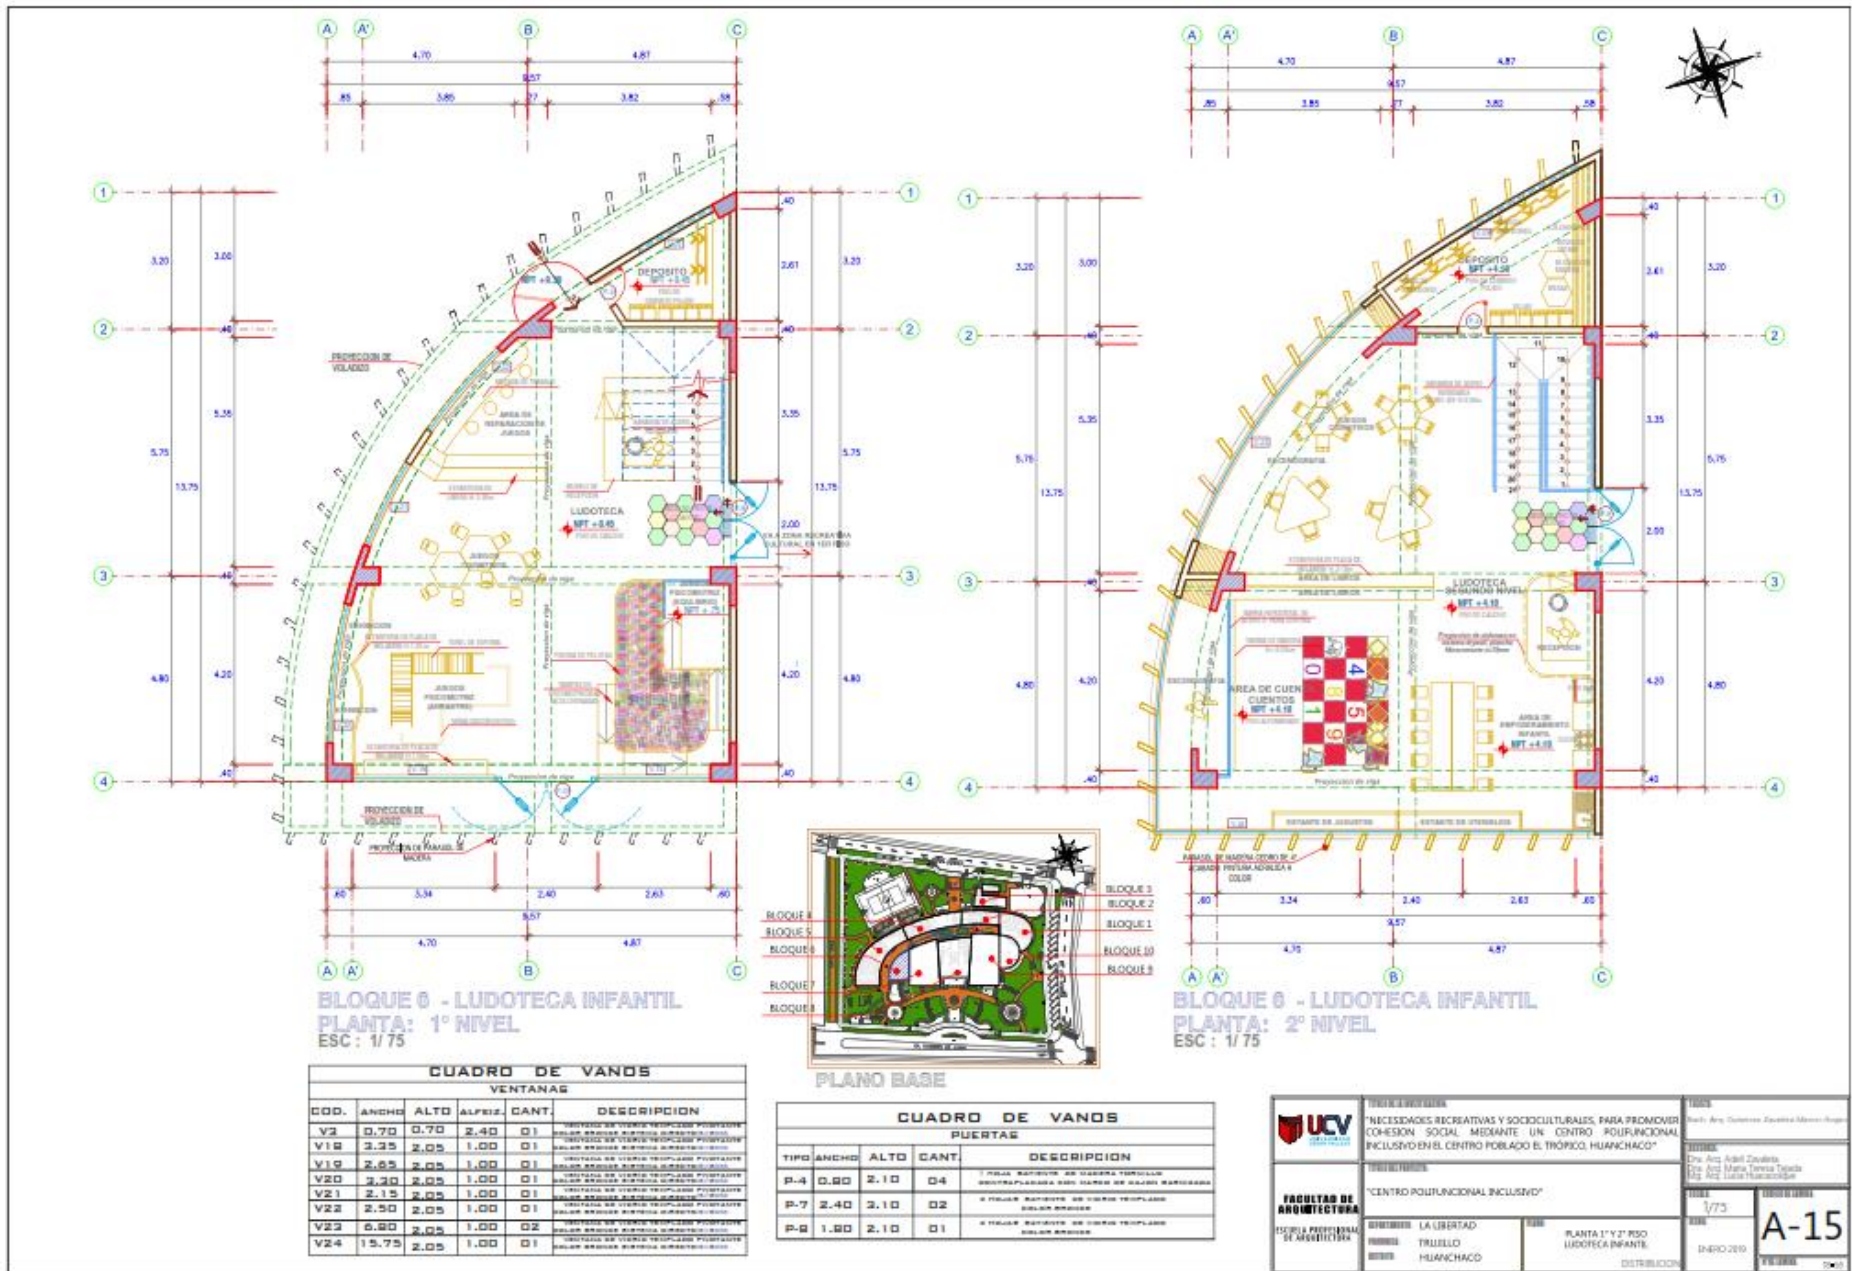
Desarrollo del bloque 6(ludoteca), Planta 1° y 2° piso: A-15. Fuente: Propia (2018)
